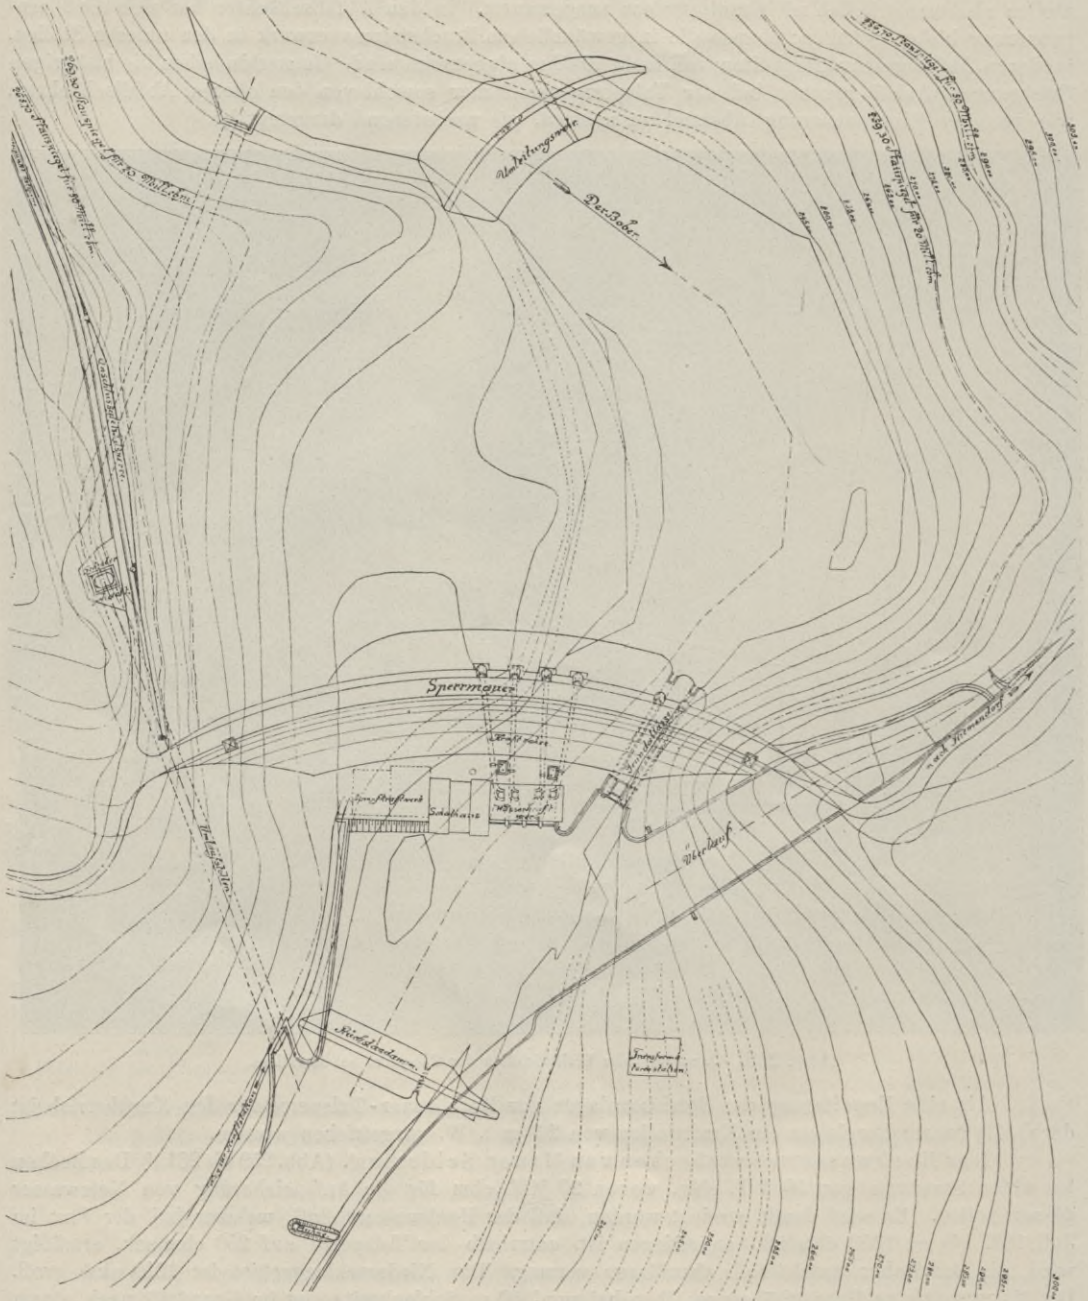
Lageplan der Hochwasserschutzdammes von Mauer am Bober (Schlesien). Ungef. Maßstab 1 : 3000.
